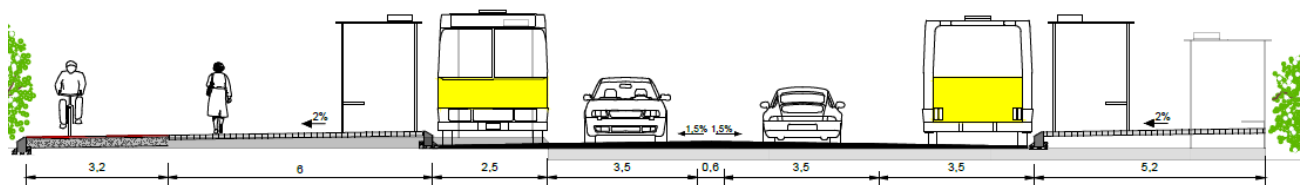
Sección 4.2. Fuente: Elaboración propia a partir de AutoCad.
